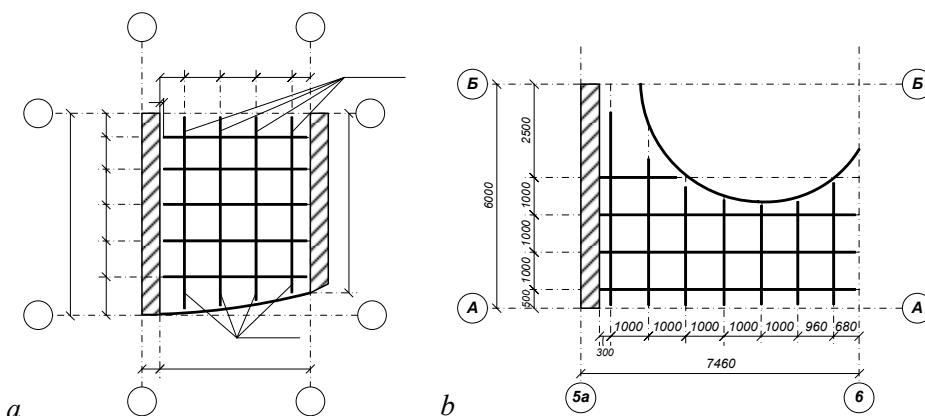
Схеми розташування посилення плит перекриття а та покриття б басейну композитними стрічками S&P CFK – Lamellen Sheet готелю "Прикарпаття" у м. Трускавець
